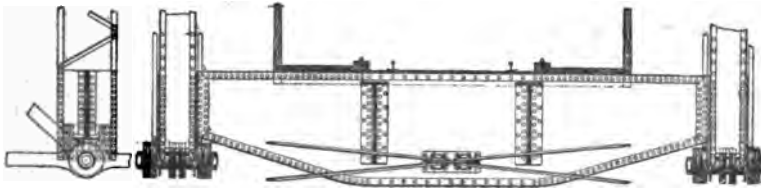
Pont de l'Ohio. Connecting Ry. Tablier et montants.
